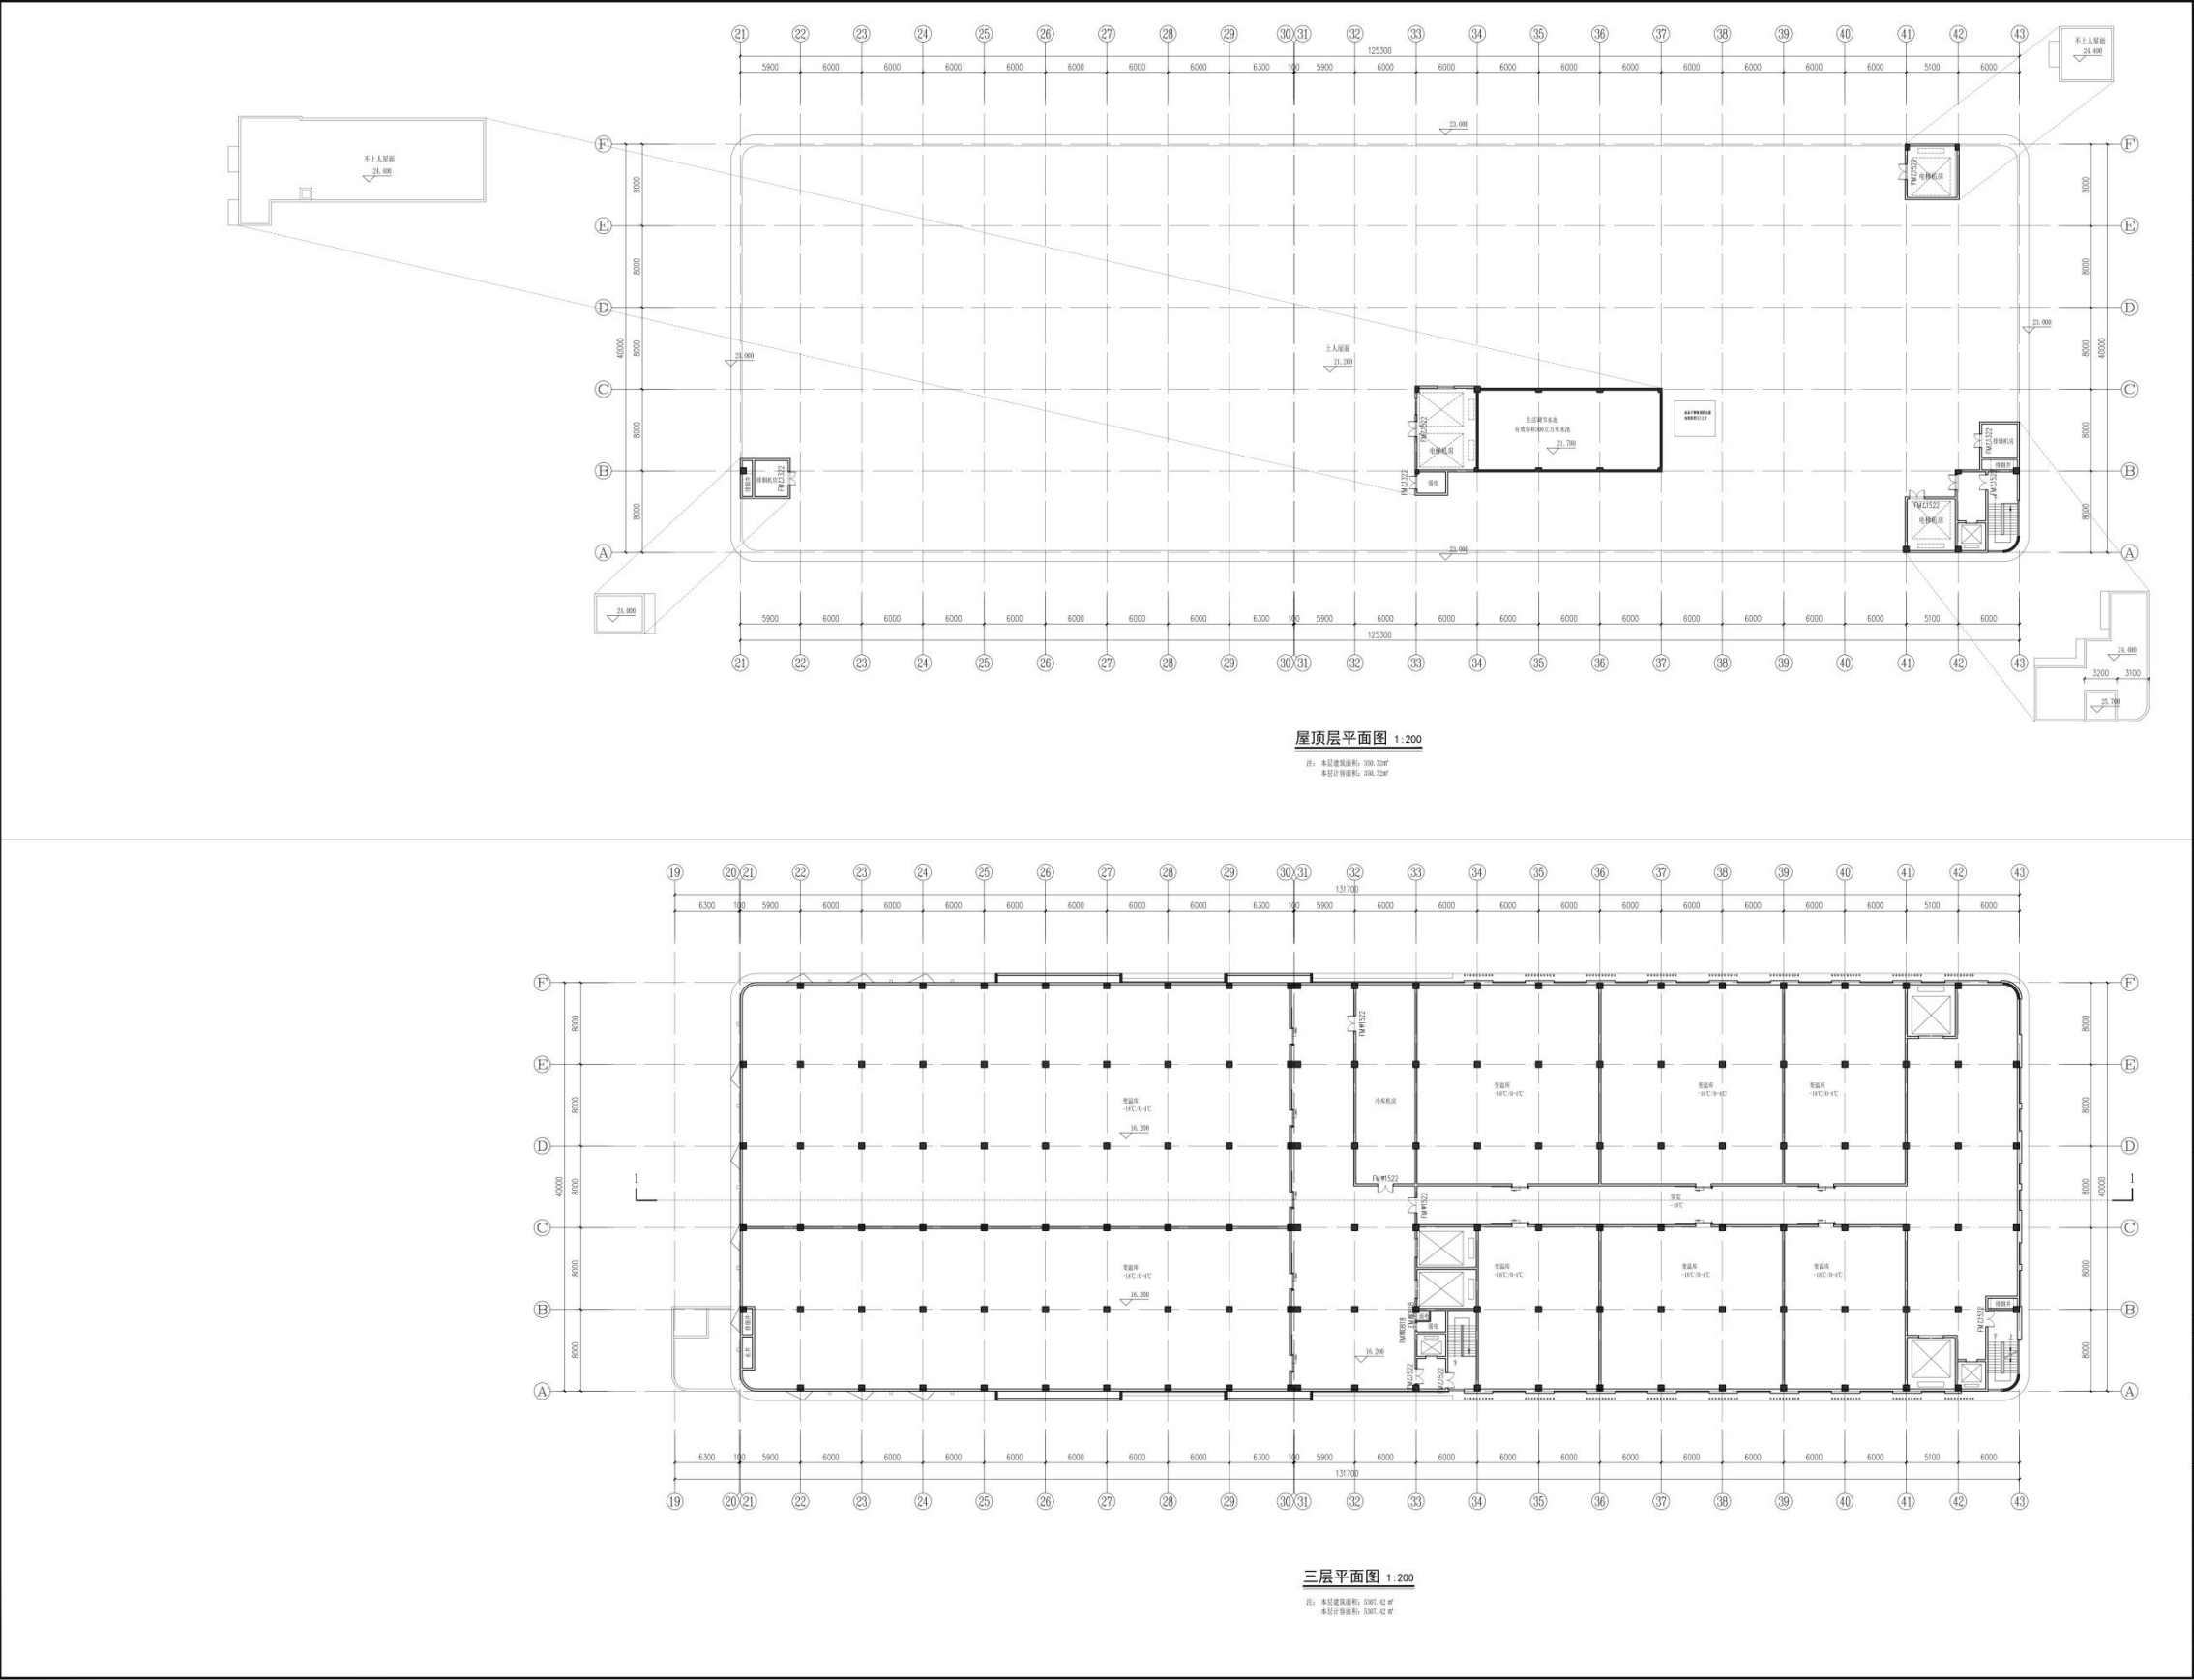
(2 栋肉食加工车间及冷库) 三层及屋顶平面图
